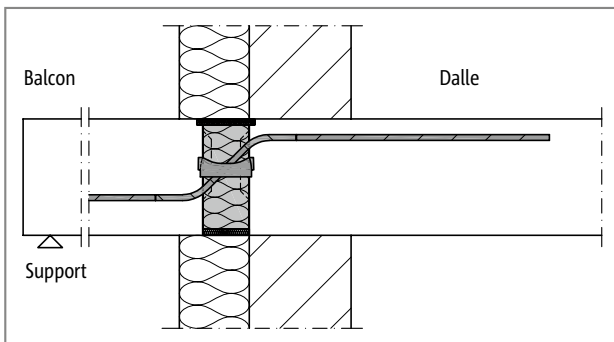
Schöck Isokorb® T Type Q-E : Raccordement pour isolation externe
